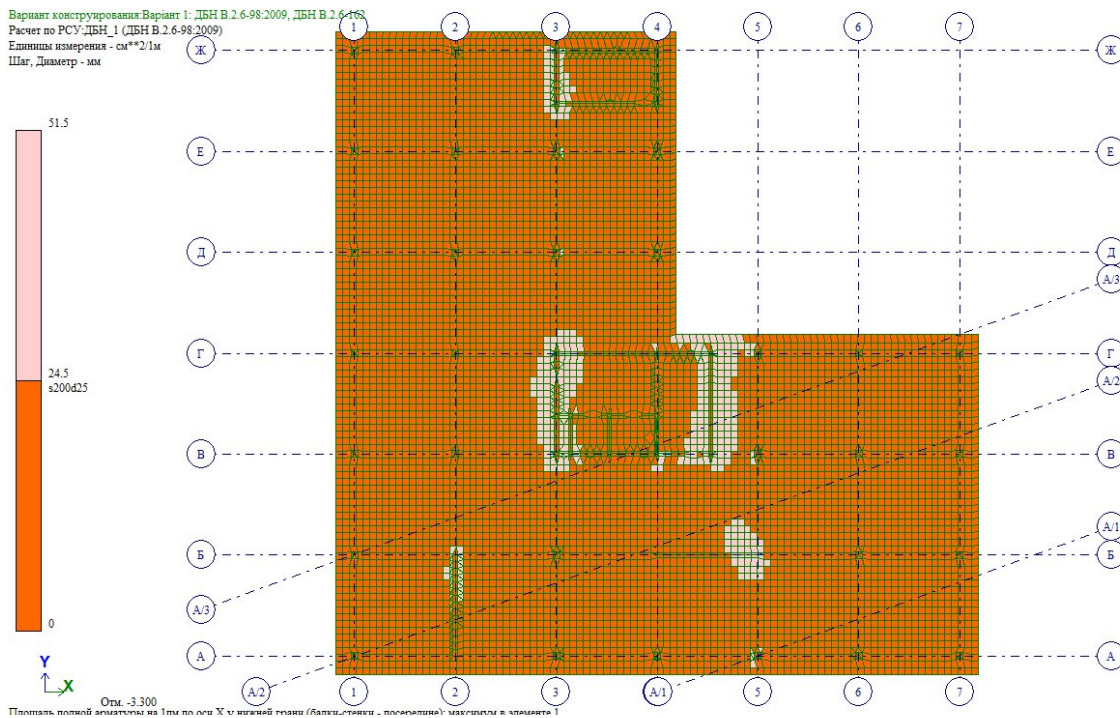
Площа арматури на 1мм біля нижньої грані по осі У
